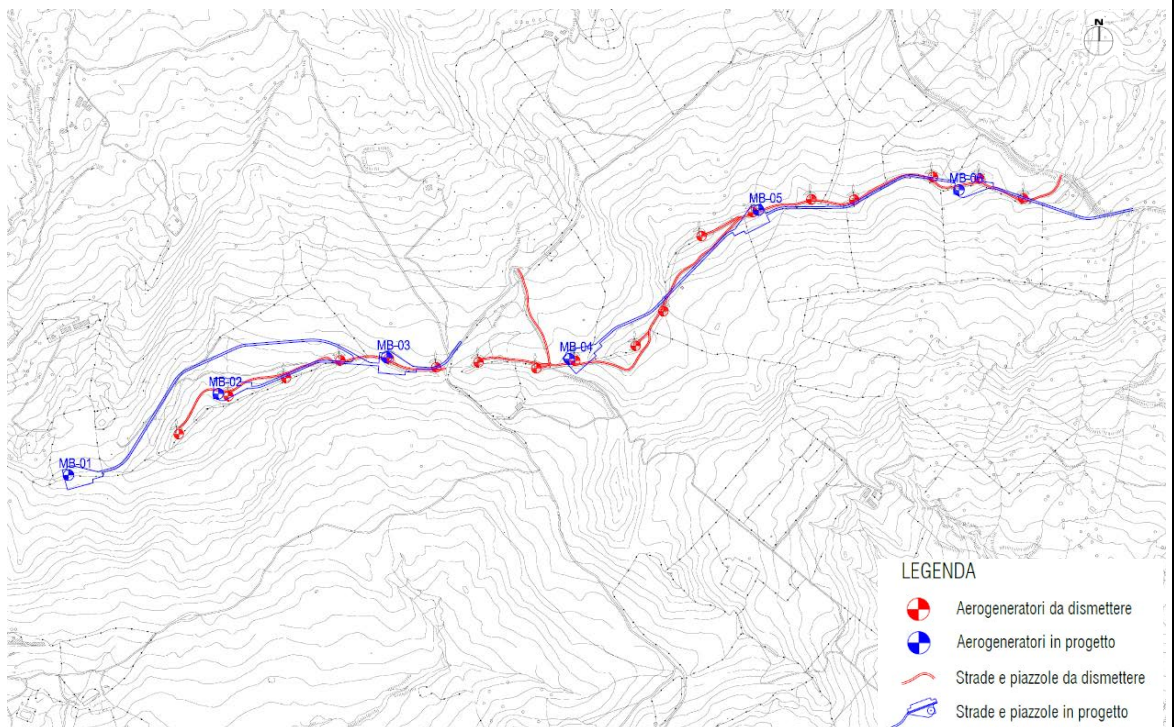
Layout di raffronto tra stato di fatto e stato di progetto
